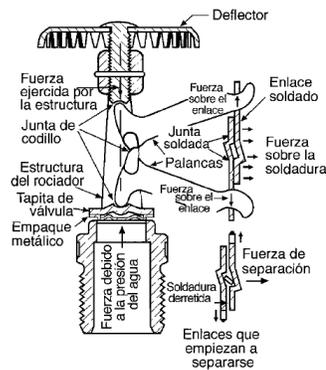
Disposición representativa de un rociador automático de enlace y palanca con soldadura
